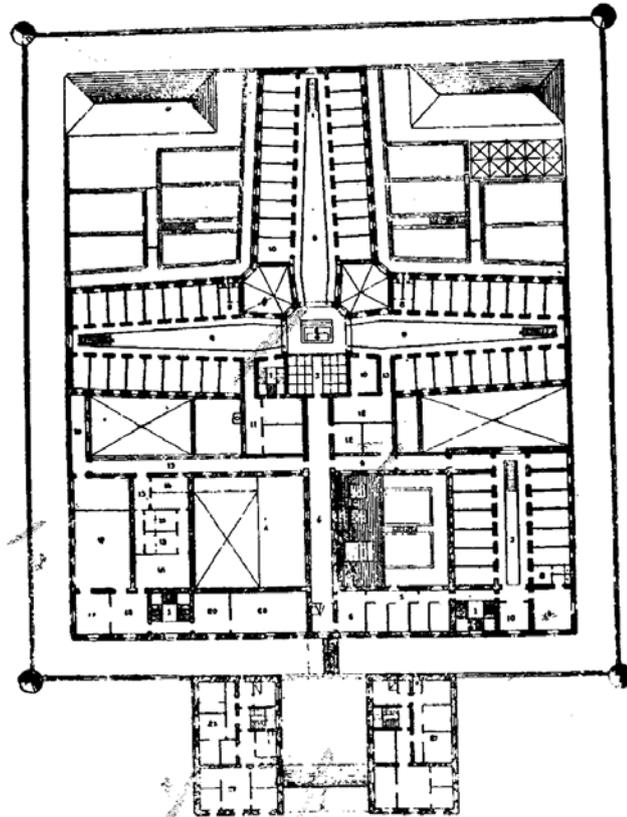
Planta baja de un proyecto de Tomás Aranguren para Madrid. Fuente: Fraile, 1987. De: Anuario Penitenciario, 1889.
